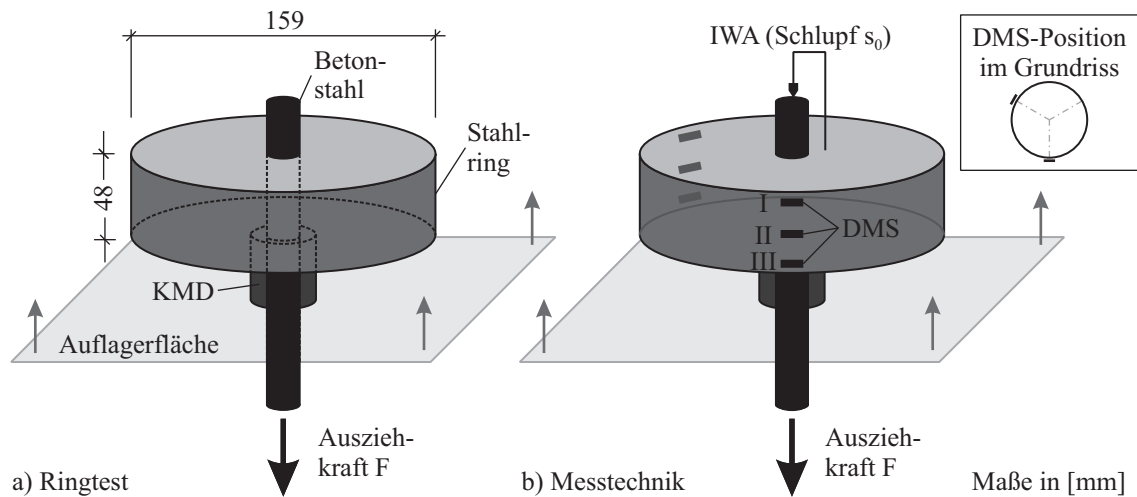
Versuchskörper und Messtechnik für die Ringtests
